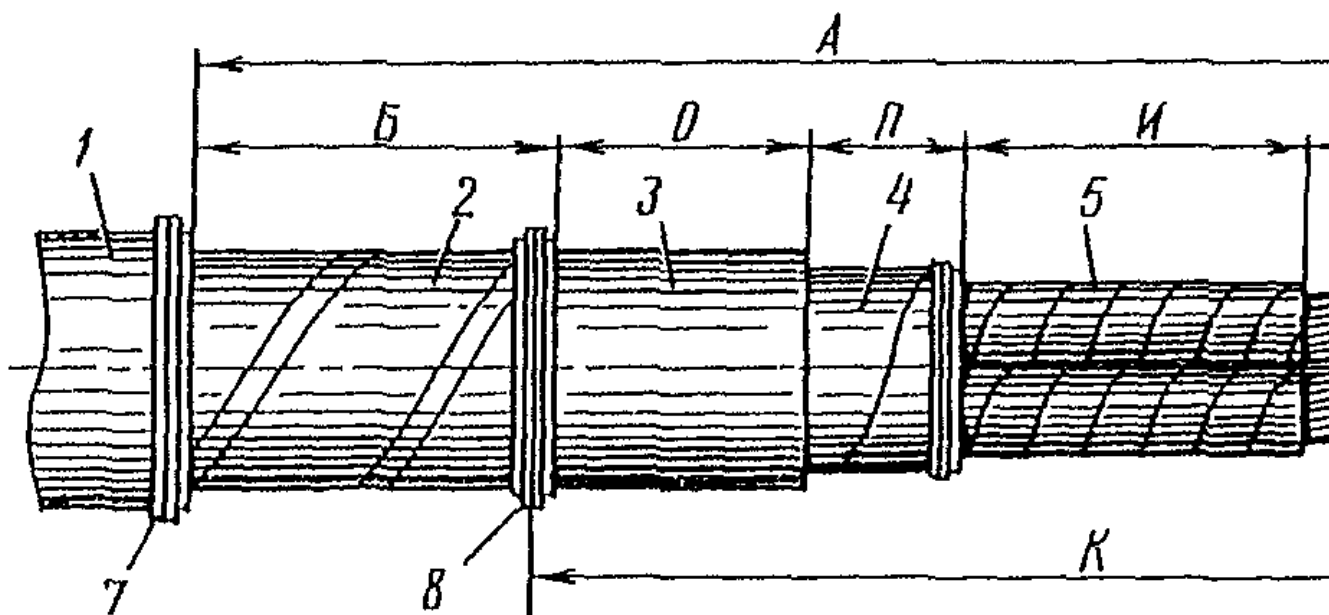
Разделка силового кабеля с бумажной изоляцией: 1 - наружный покров; 2 - броня; 3 - металлическая оболочка; 4 - поясная изоляция; 5 - изоляция жил; 6 - жила кабеля; 7 и 8 - проволочные бандажи
